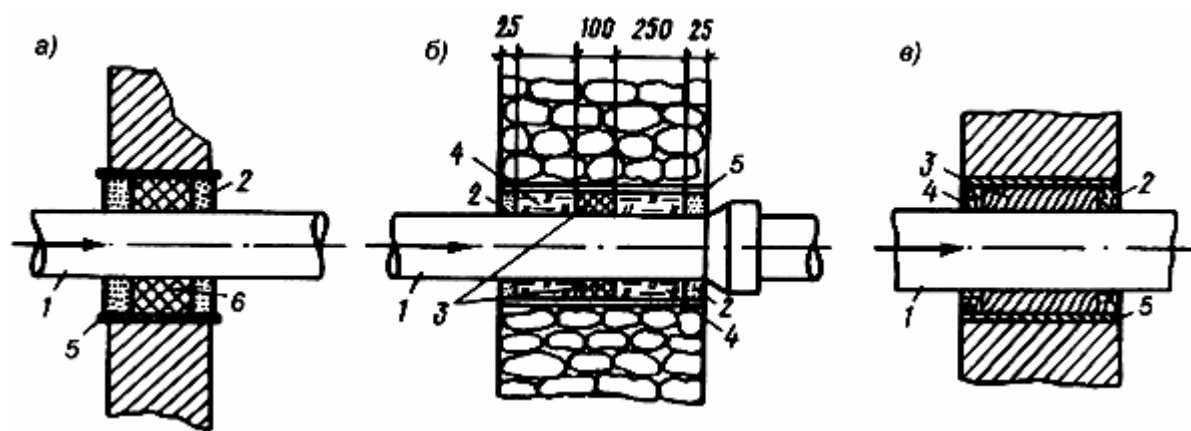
Варианты заделки вводов во влажных (мокрых) грунтах
